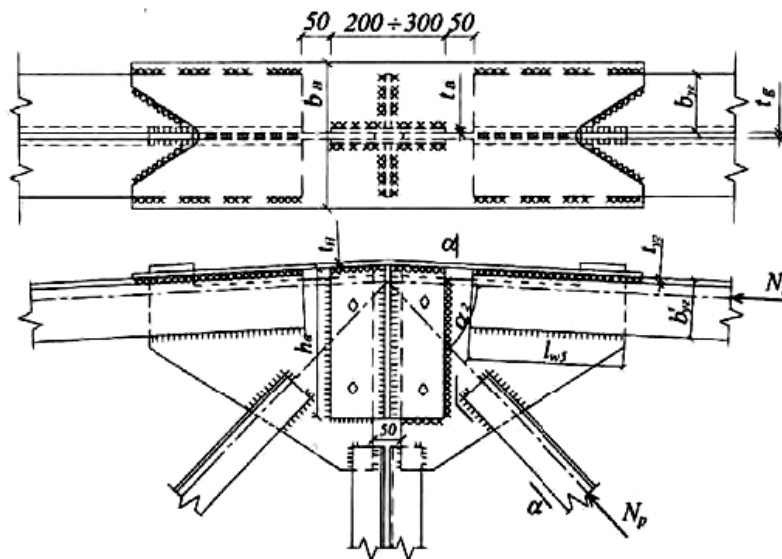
Укрупнительный узел верхнего пояса стропильной фермы
